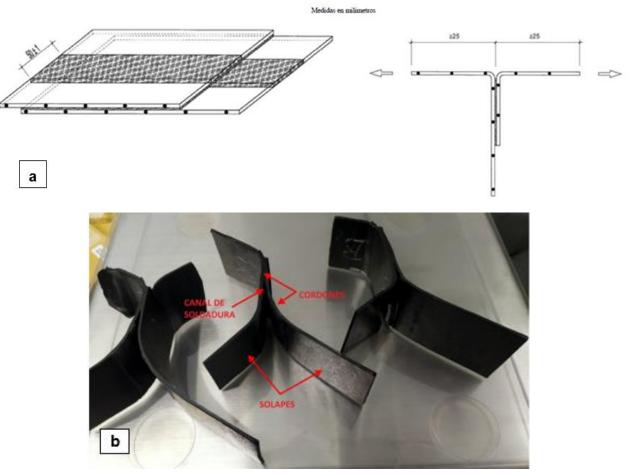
Resistencia de la soldadura por pelado: (a) esquema de la probeta según la norma UNE 104304, (b) ejemplo de pelado y propagación dentro del cordón de soldadura
